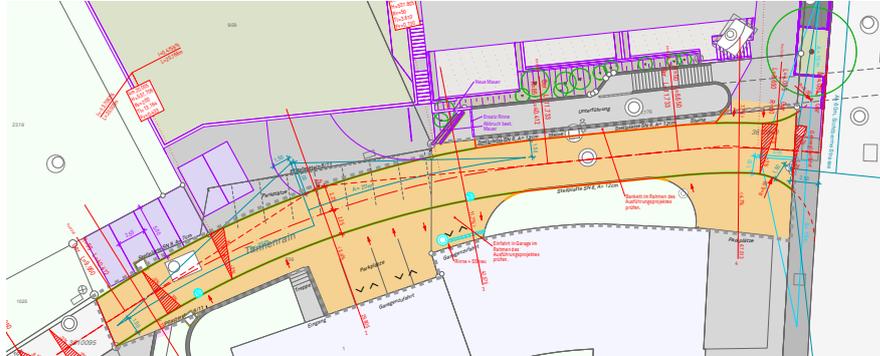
Ausschnitt Situation Bauprojekt (nicht massstäblich).
